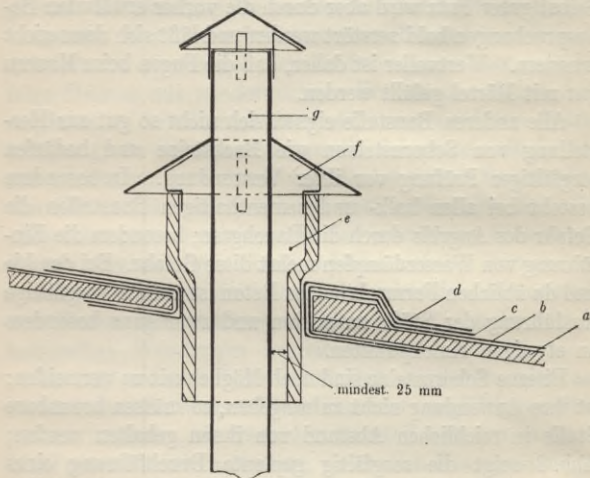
Durchführung eines Blechschornsteines durch ein Teerpappdach, nach Branddirektor Lücke. — a) Dachschalung. — b) Dachpappe. — c) Asbest. — d) Blechbeschlag. — e) Tonrohr. — f) Schutzkappe. — g) Rauchrohr.
